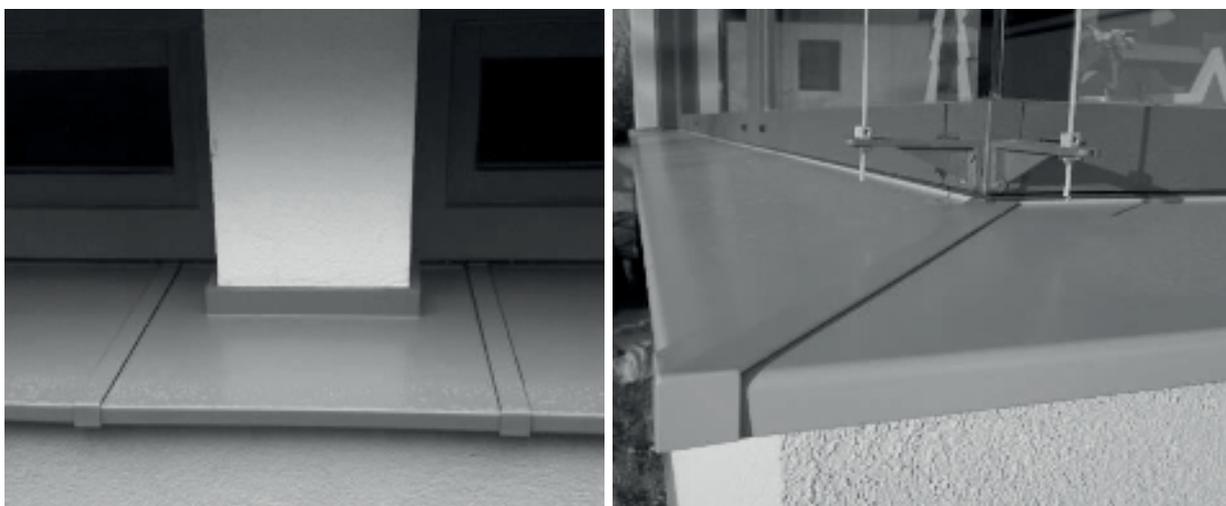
Fensterbank mit Stoßverbinder und Eckausführung
